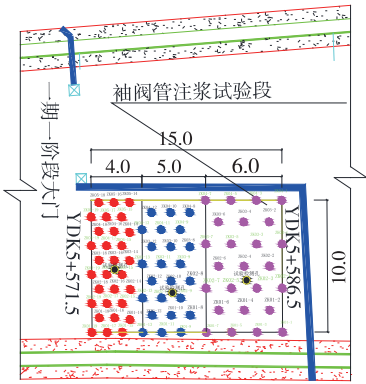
袖阀管注浆试验段检测孔平面布置(单位:m)
